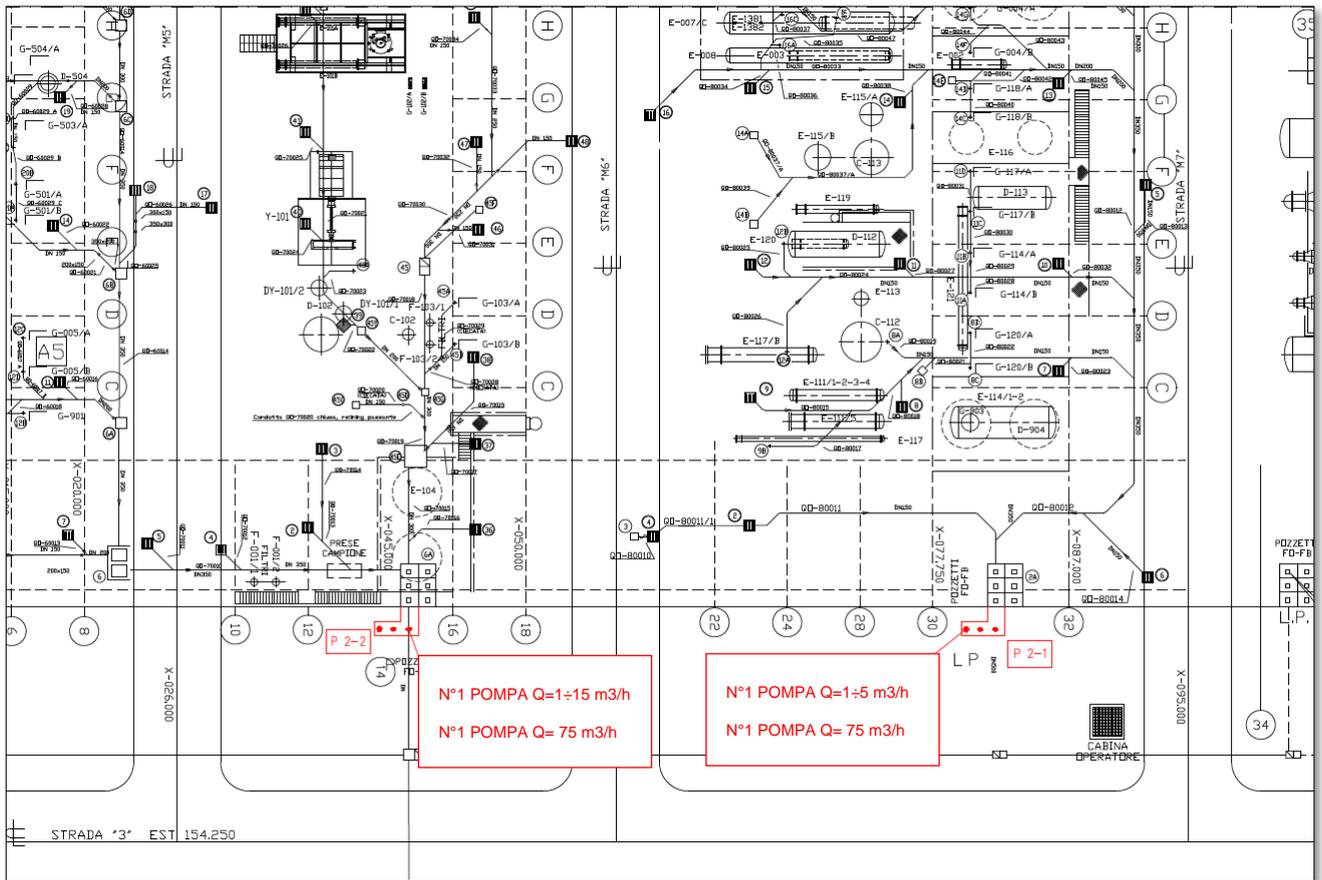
Dettaglio posizionamento planimetrico delle nuove pompe presso scarichi P 2-1, P 2-2
